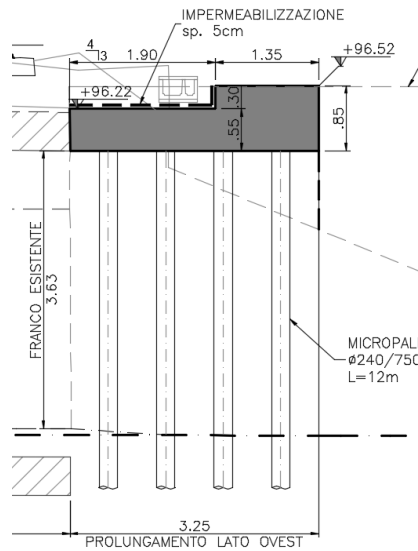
Sezione longitudinale del prolungamento lato Ovest
